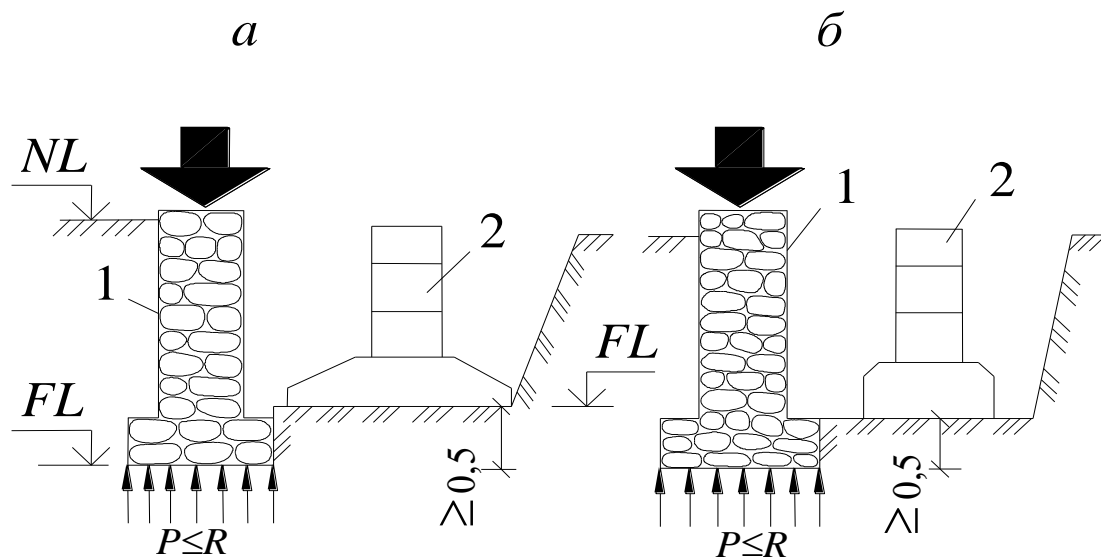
Розташування існуючих (1) і запроектованих (2) фундаментів, за якого виключають видавлювання ґрунту: а – примикання фундаментів упритул; б – примикання фундаментів при незначному віддаленні
